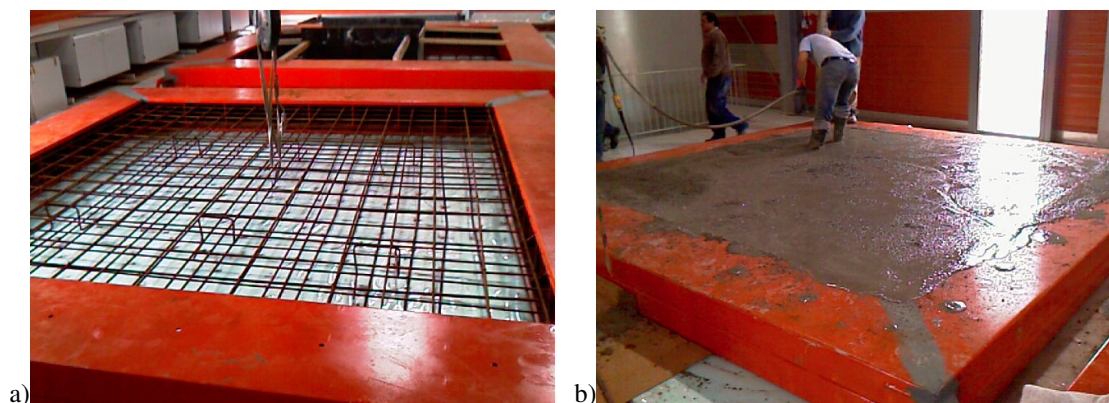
Execução do provete vertical em betão armado nas instalações do *ITeCons*: a) imagem real no aro metálico com a malha quadrada superior e inferior; b) betonagem do elemento e vibração do betão.
